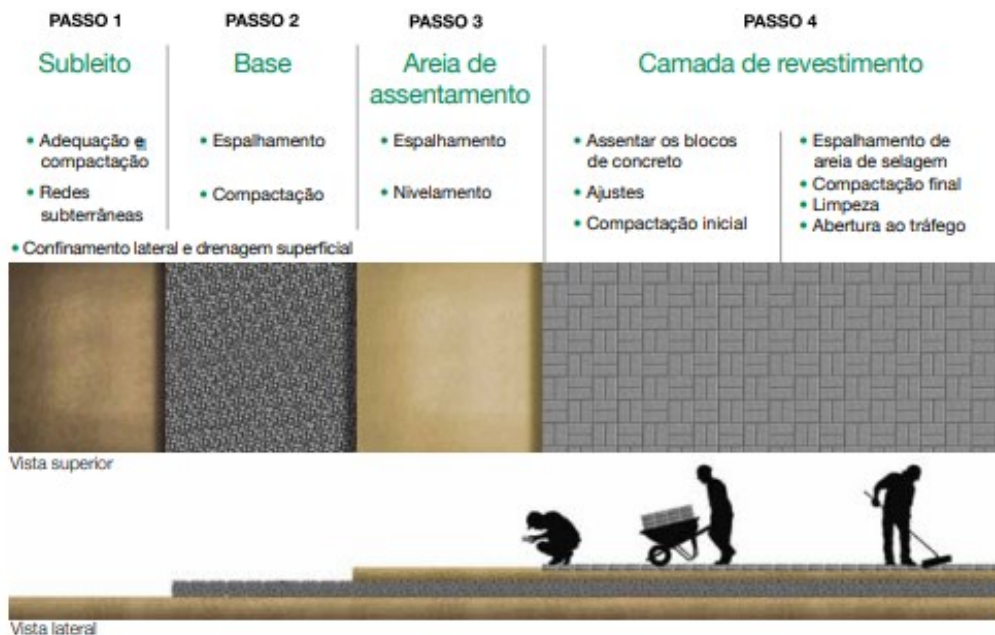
Estrutura típica dos pavimentos intertravados de concreto
